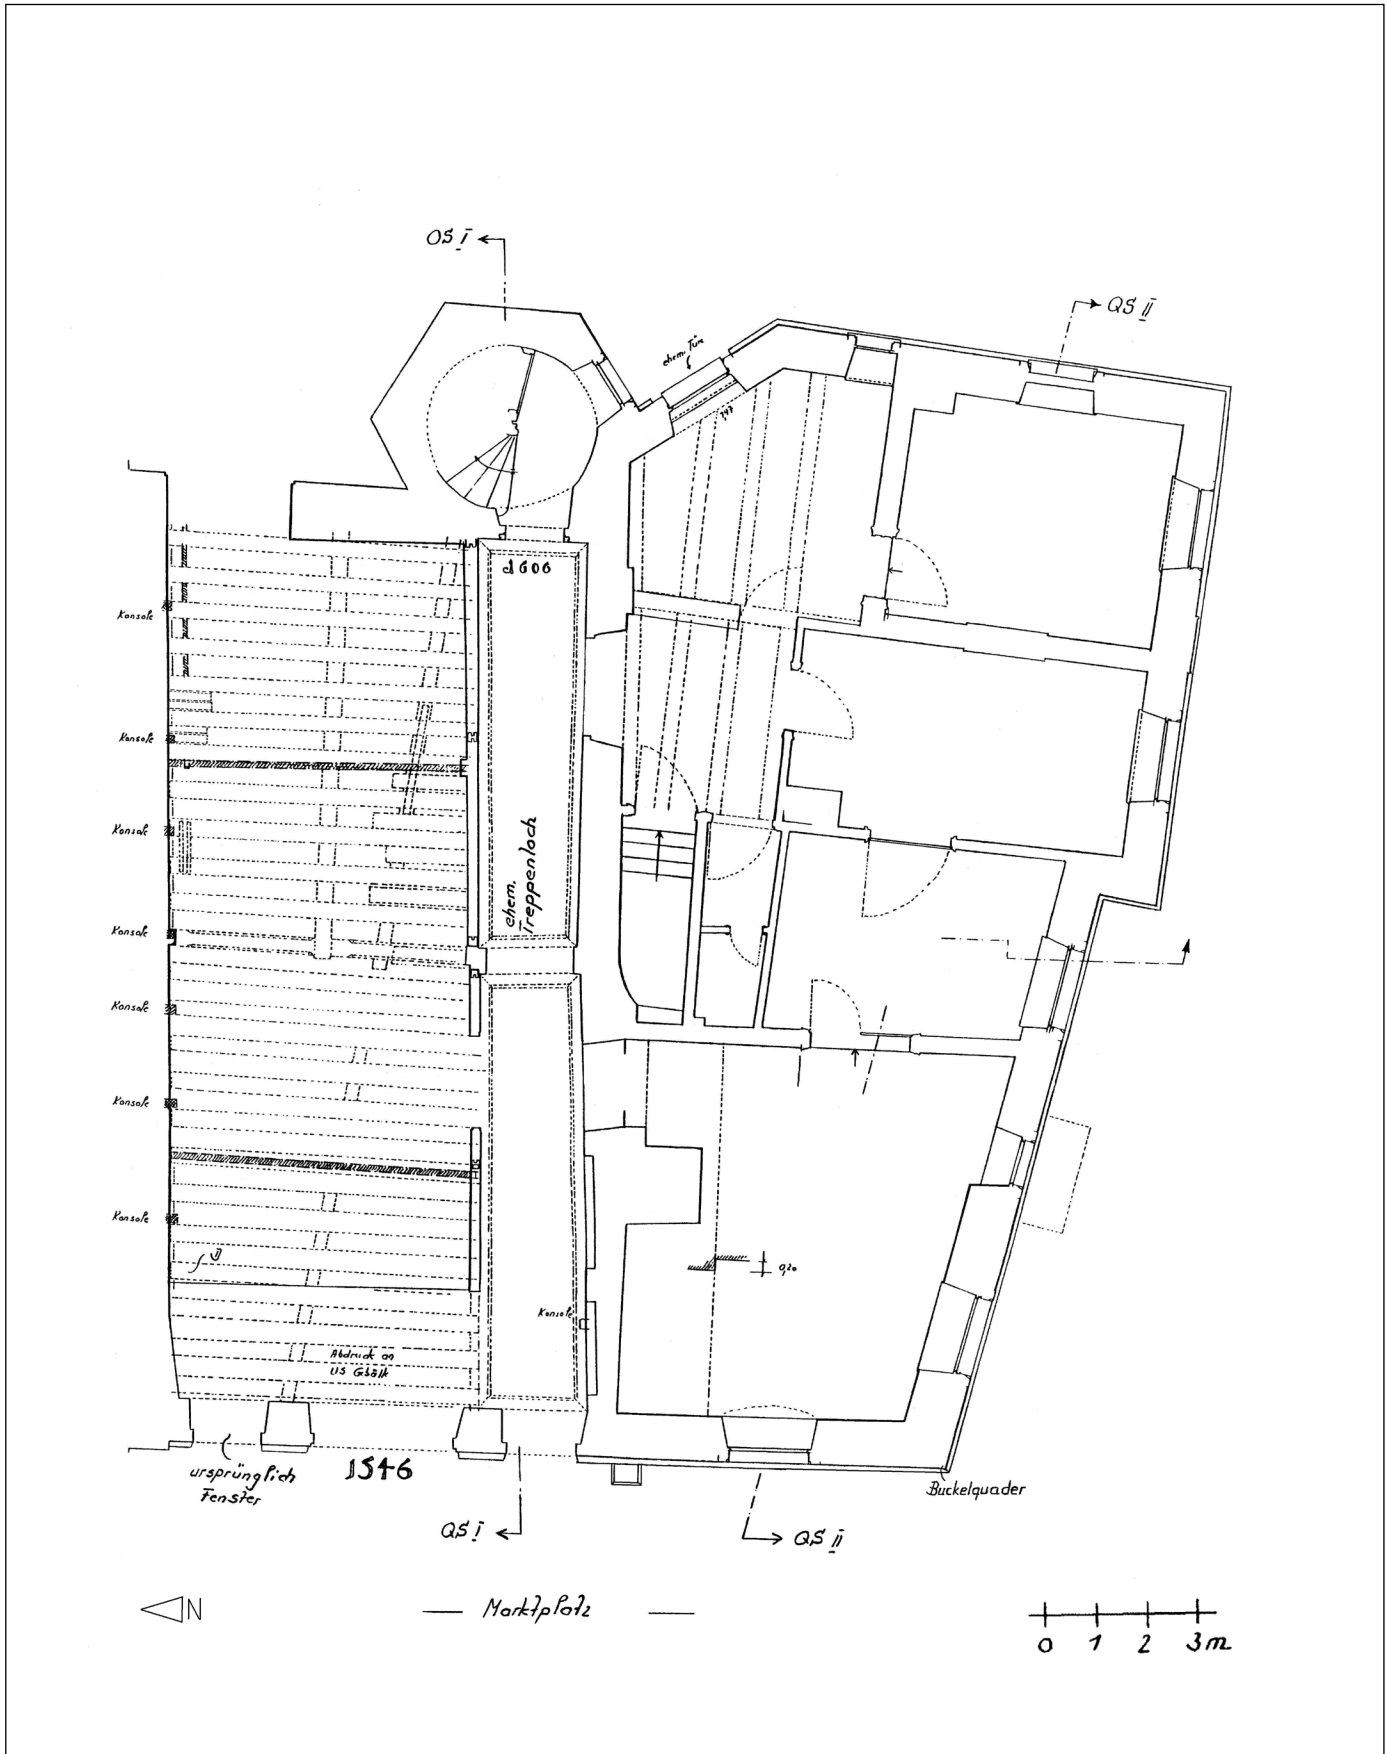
Hauptstraße 53, Rathaus, Grundriss Erdgeschoss, M. 1:150.
